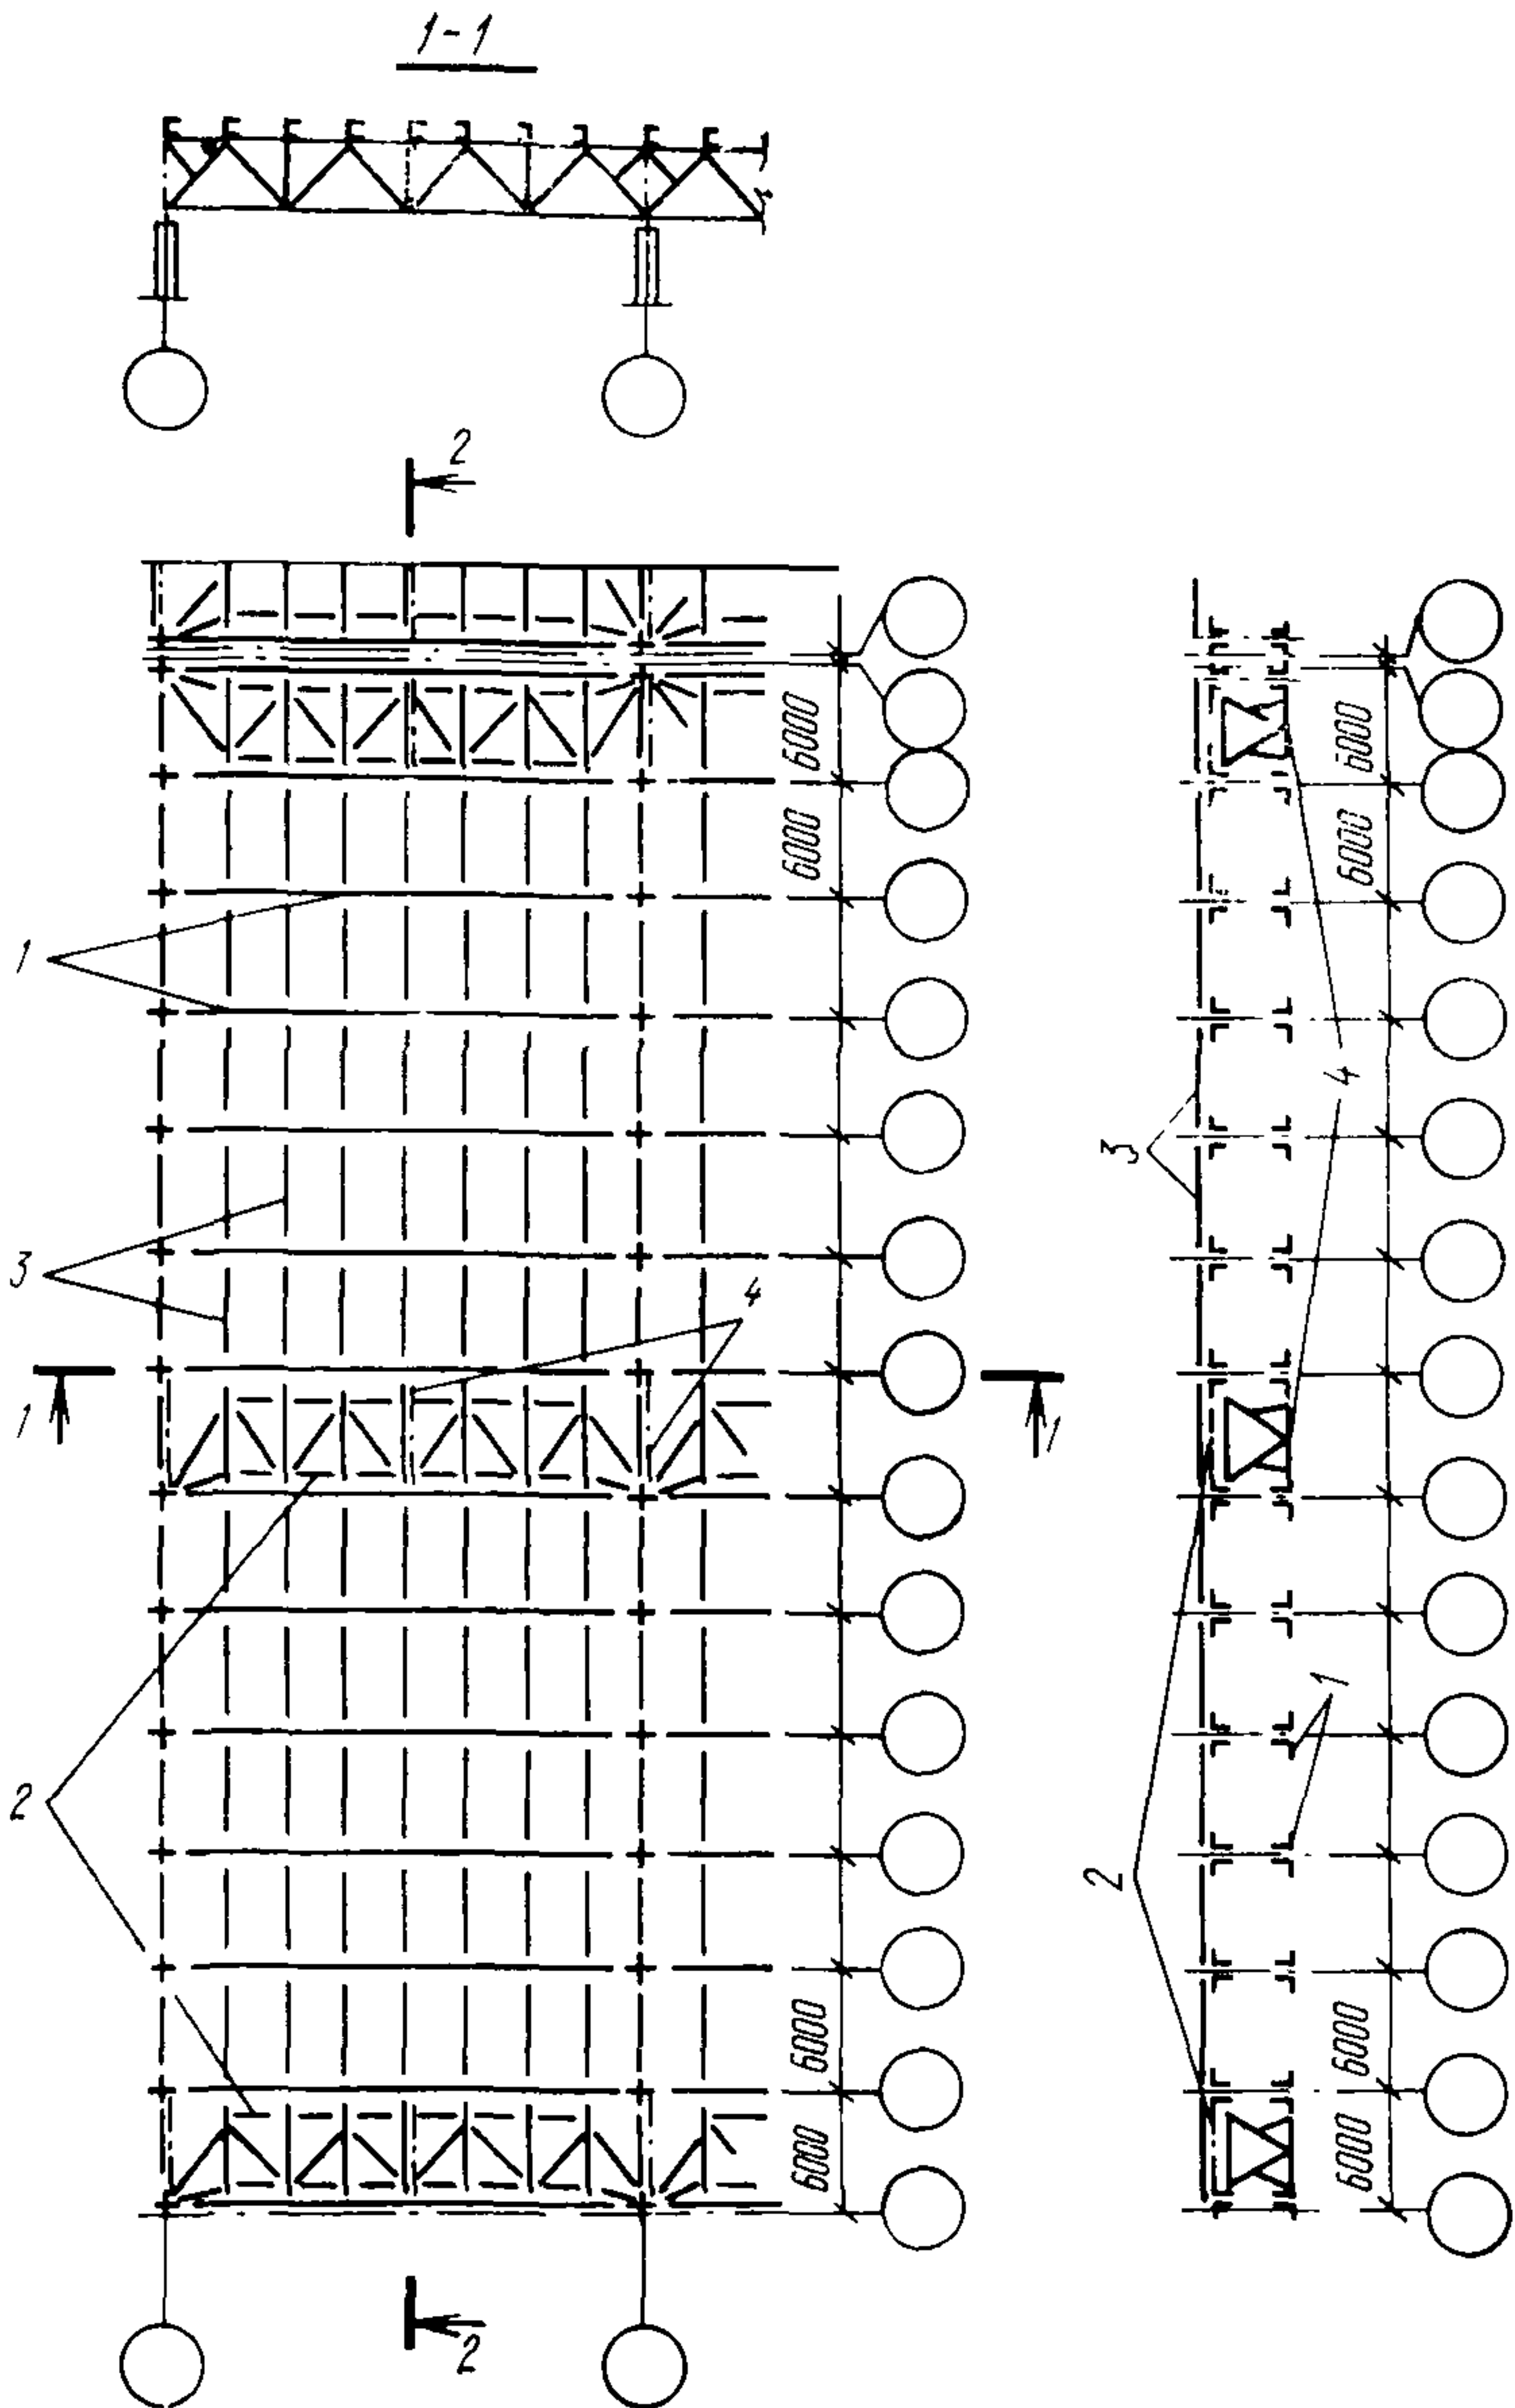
Пример расположения связей по верхним поясам стропильных ферм покрытия с прогонным решением кровли
